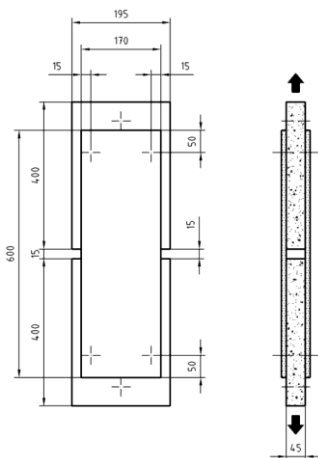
Испытываемый образец для определения прочности обшивки на сдвиг по [8]
